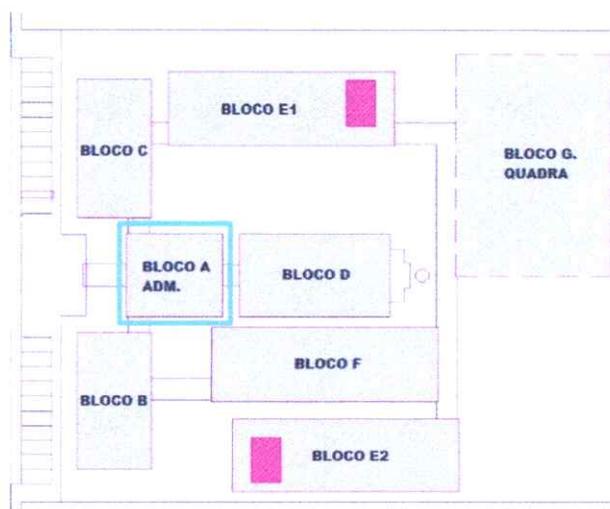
Layout dos Blocos, conforme Projeto de Arquitetura. Fonte: Projeto Padrão FNDE.
